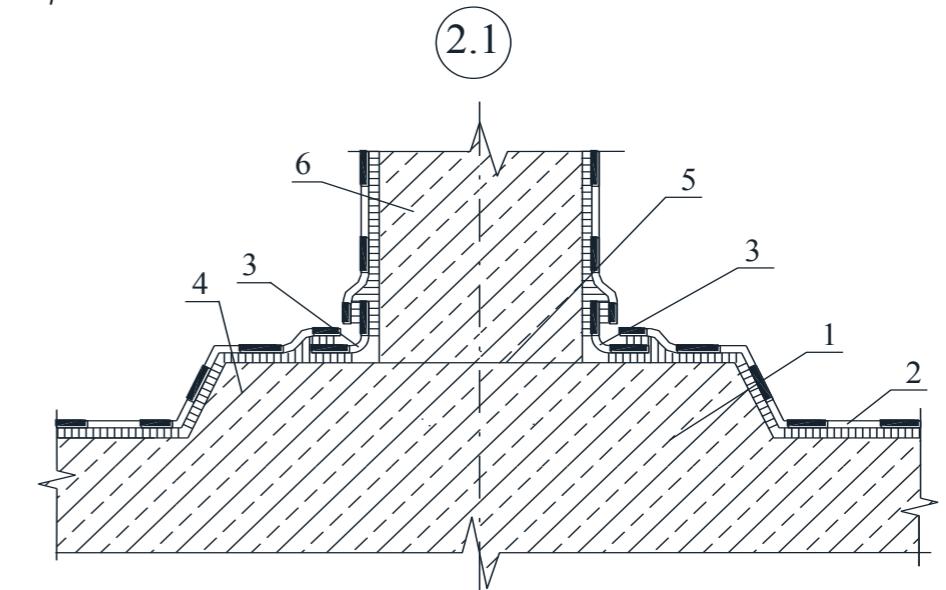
Узел 2.1 Гидроизоляция внутренней колонны бассейна градирни со стаканом фундамента
